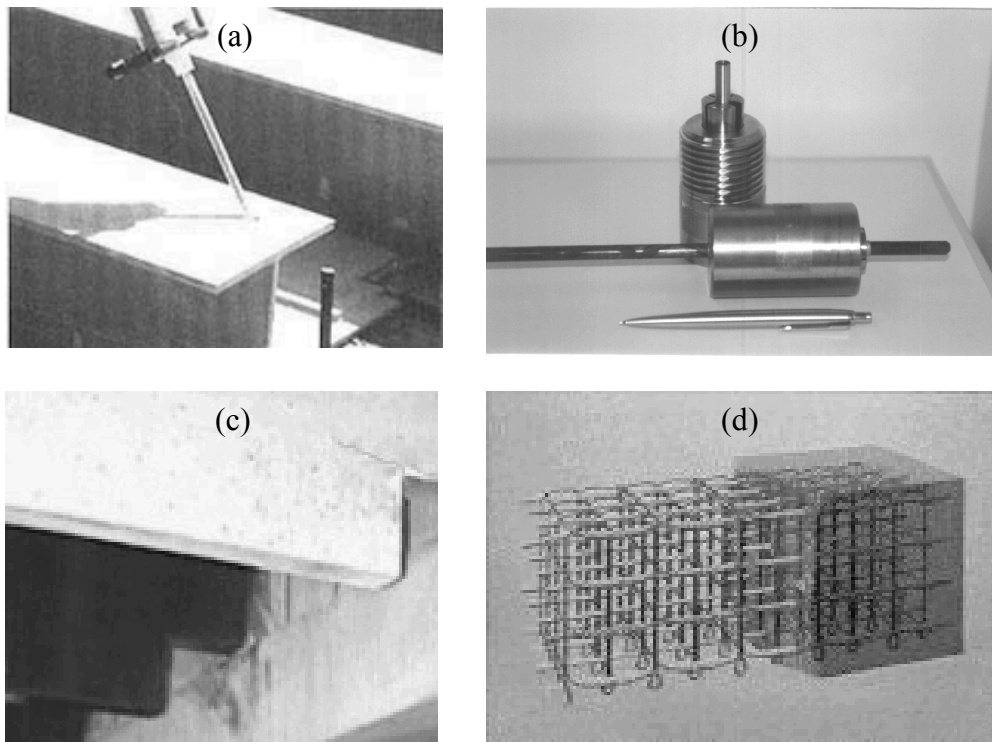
Ejemplos de aplicaciones de los FRP en la construcción. (a) Perfiles estructurales. (b) Refuerzo de vigas de hormigón. (c) Tendones de pretensado. (d) Sistema estructural.
